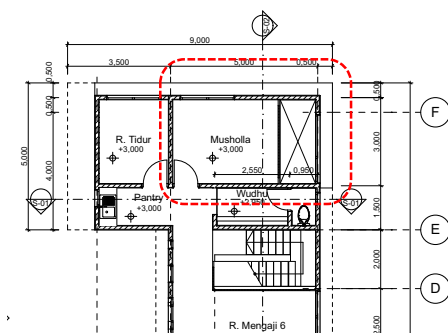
Denah lantai atas dan area penambahan ruang tidur di lantai atas (ditandai)
